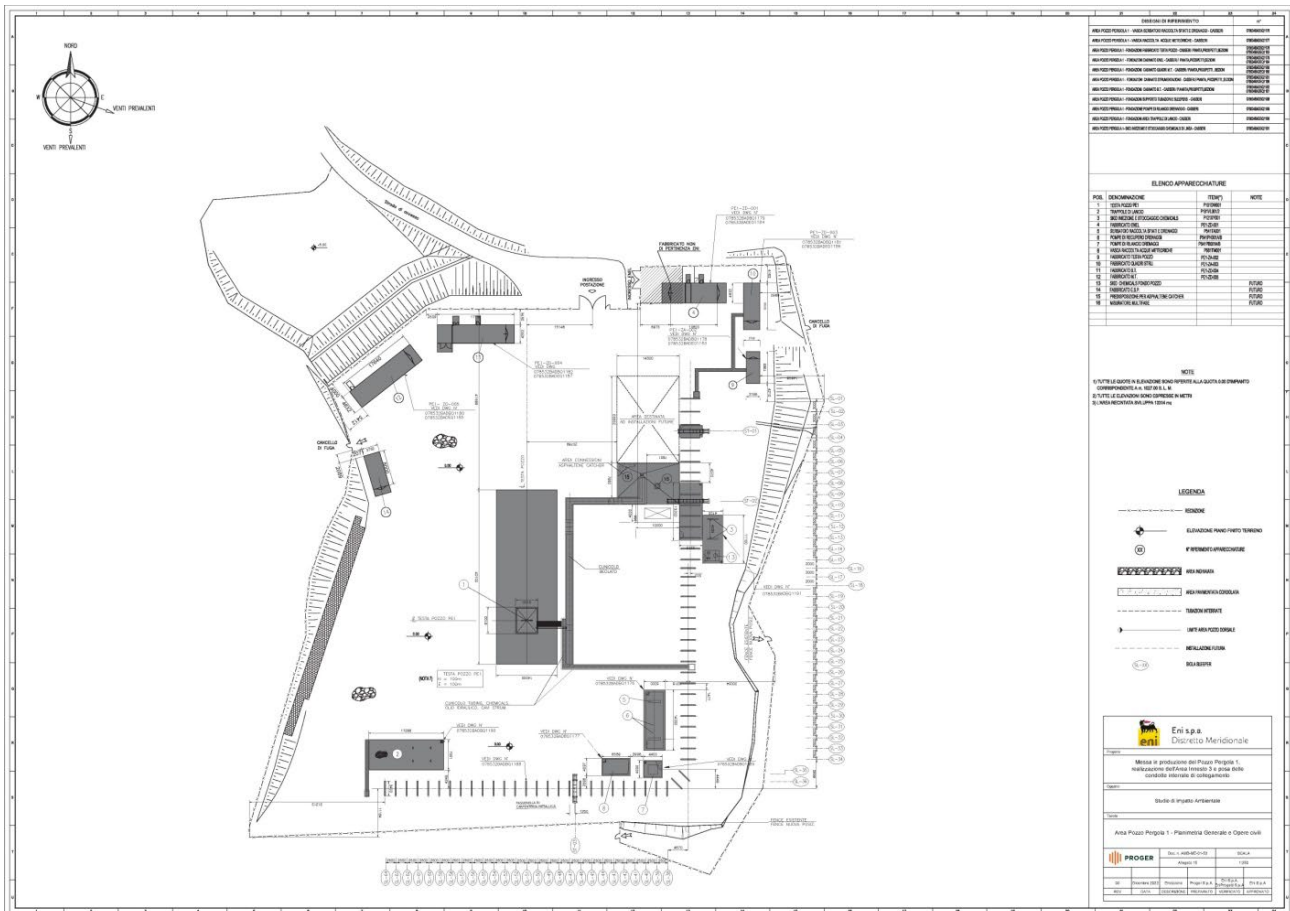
Pozzo PE1 Planimetria generale e Opere civili (Doc. n. AMB-ME-01-53 all.15)
